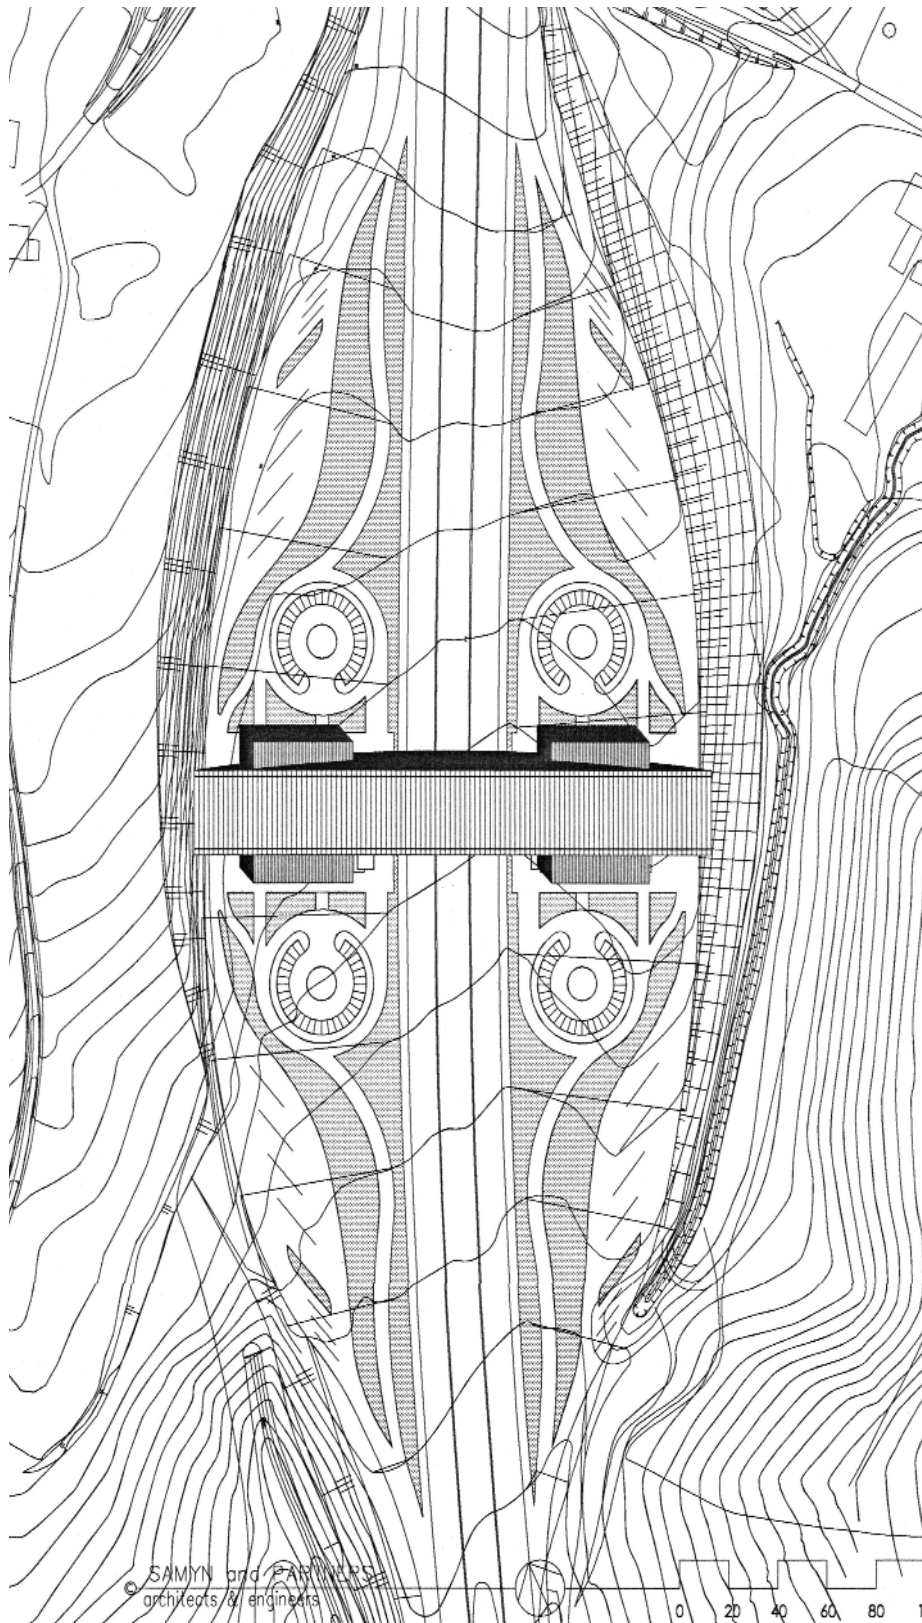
Progetto definitivo - Planimetria generale (Samyn & partners)
